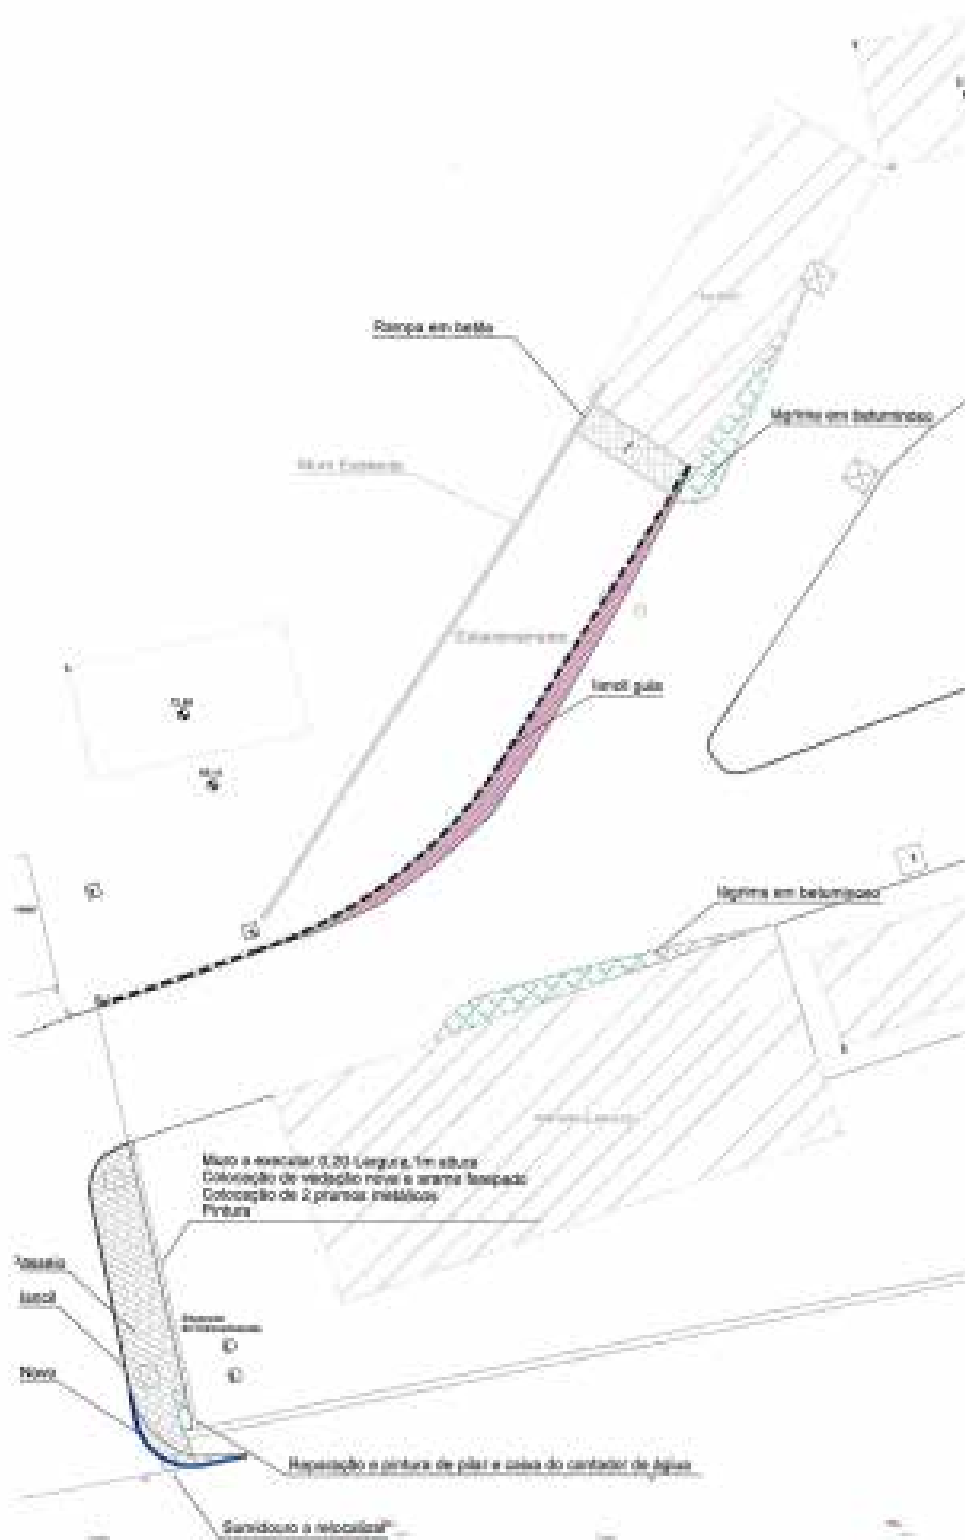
Solução final para os arranjos exteriores. (Ilustração nossa, 2018).
